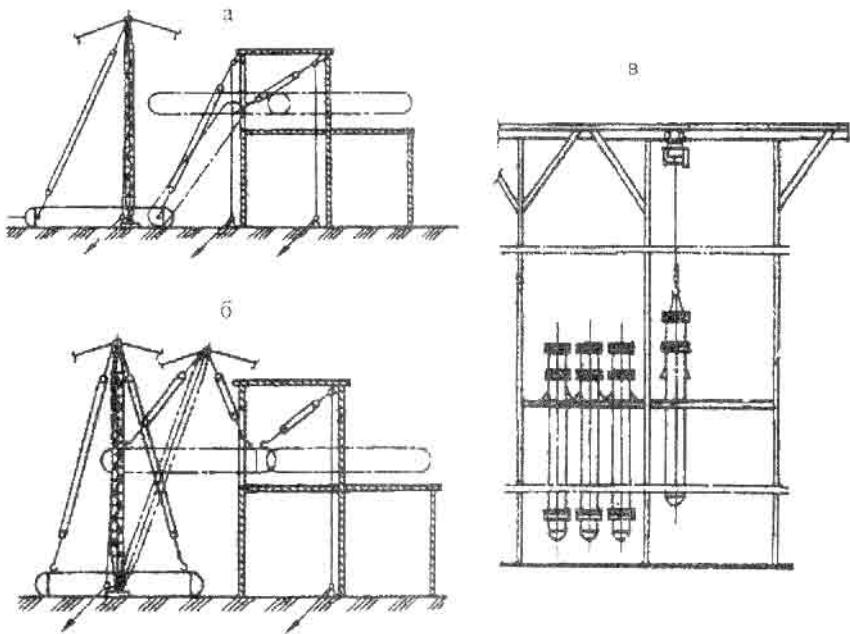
Схемы монтажа теплообменных аппаратов под перекрытием:
